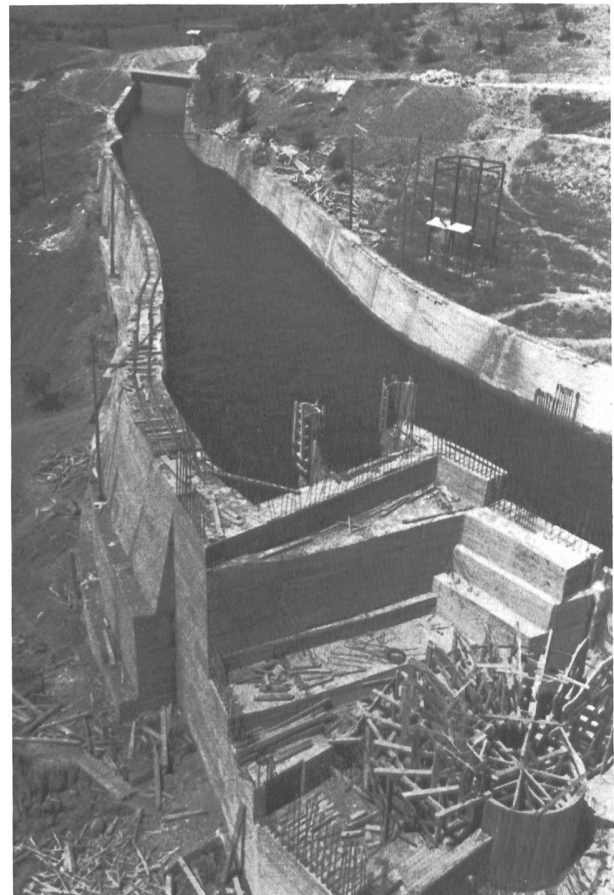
Vom Stausee Orellana abgehender Bewässerungskanal (Canal de Orellana); im Vordergrund das im Bau stehende kleine Kraftwerk (siehe Legende Bild 57)
